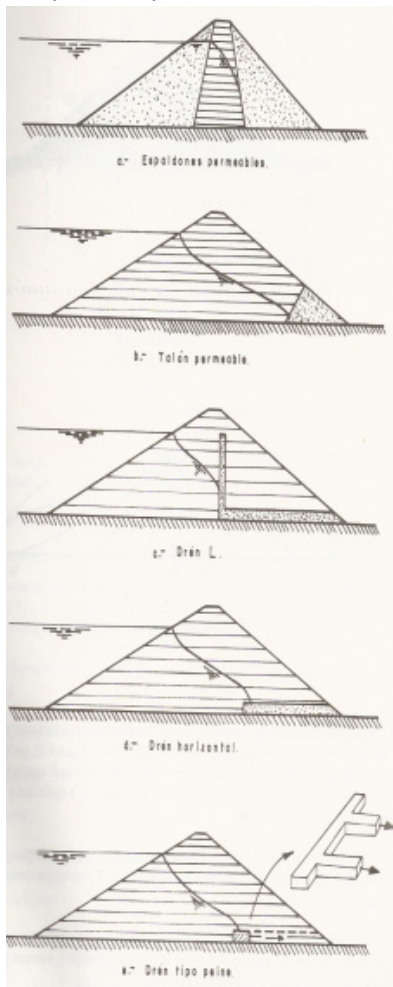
Formas de drenaje interno. (Suárez, 1993)
